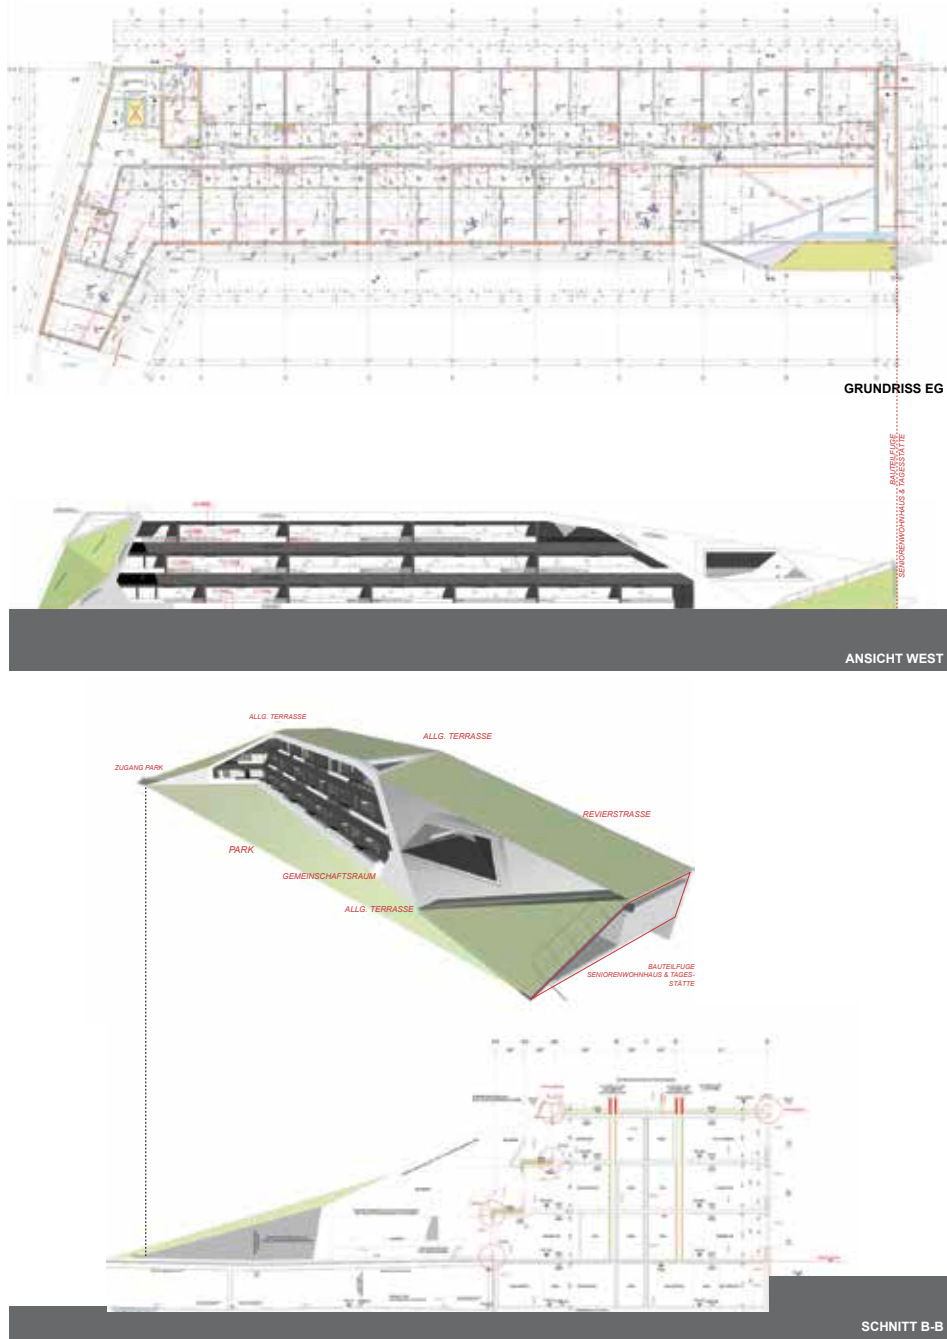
Projekt Parklife – Grundriss, Ansicht, Schnitt
